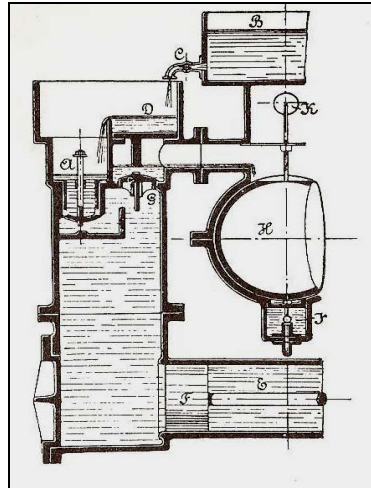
4 - Compresor empleado en el túnel de Mont-Cenis [4].
